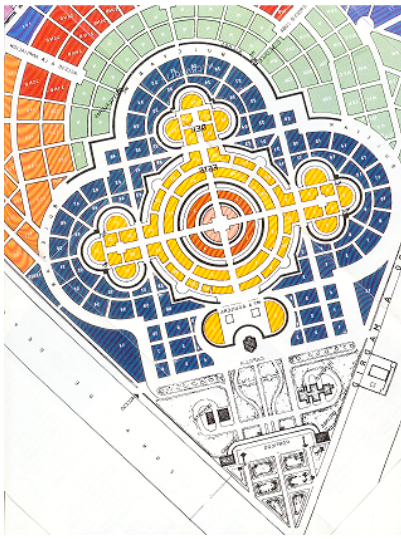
Planta del cementerio de la Alameda de Madrid
